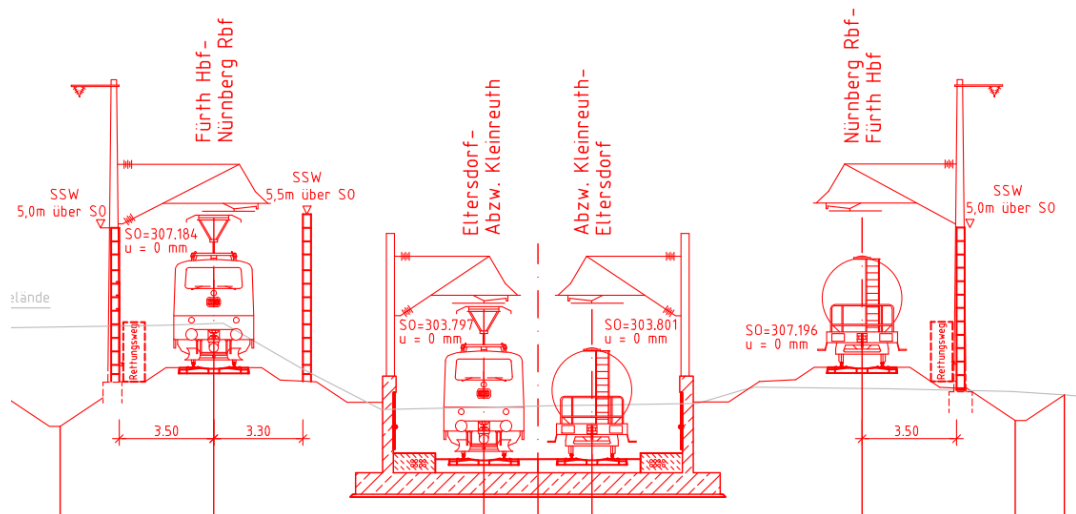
Streckenquerschnitt mit Außenmasten und Einfachausleger
